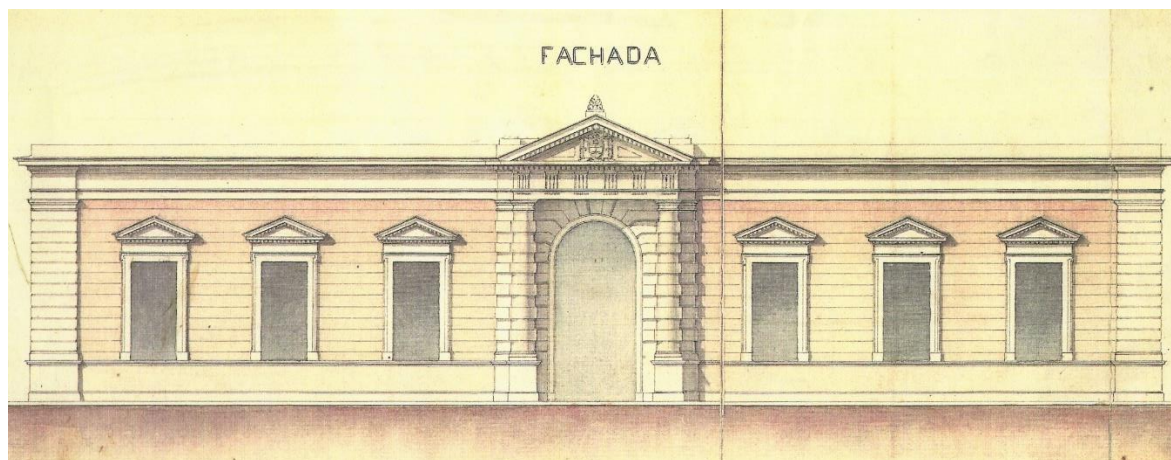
Fachada proyectada por Pompeyo Moneta, Plano N° 3, 1875 detalle. DNOA
